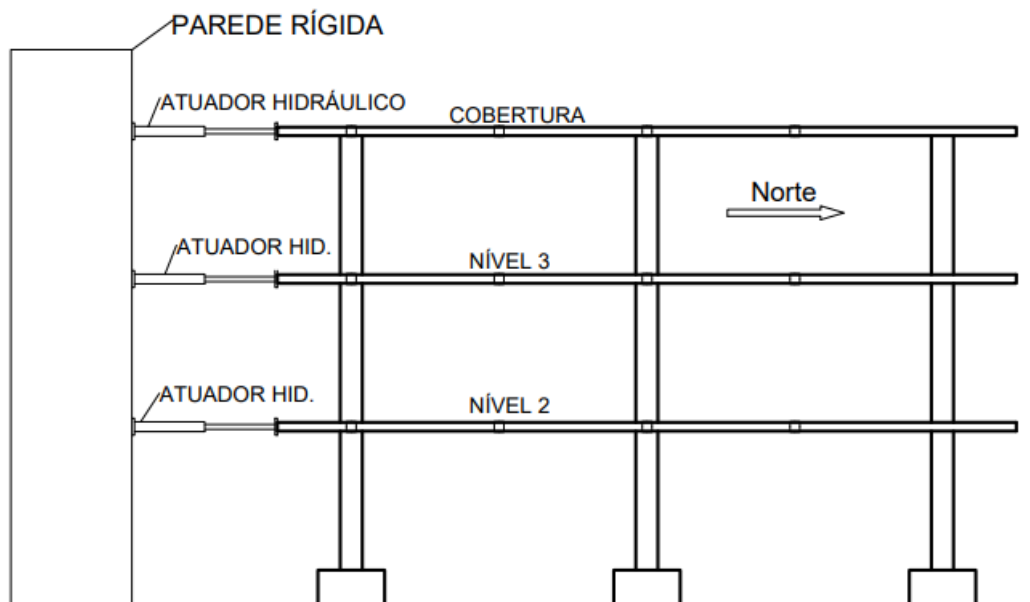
Vista em lateral do sistema de ensaio utilizado. Adaptado de Fick (2008).
